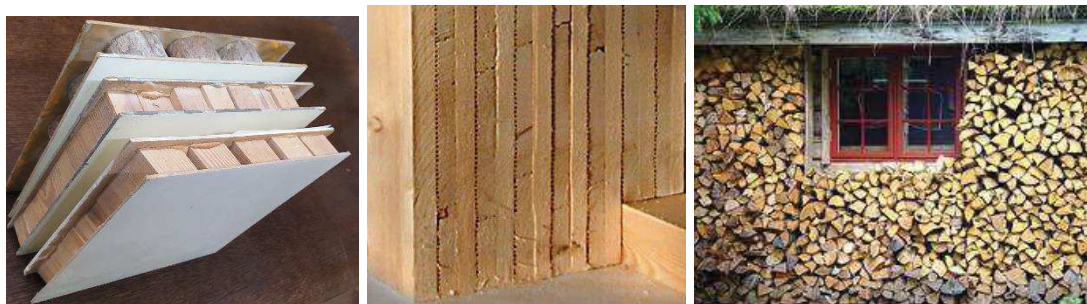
Примеры использования ретродревесины: торцовой шашки в среднем слое, досок в строительных панелях МНМ «чуркобетона» в стене
